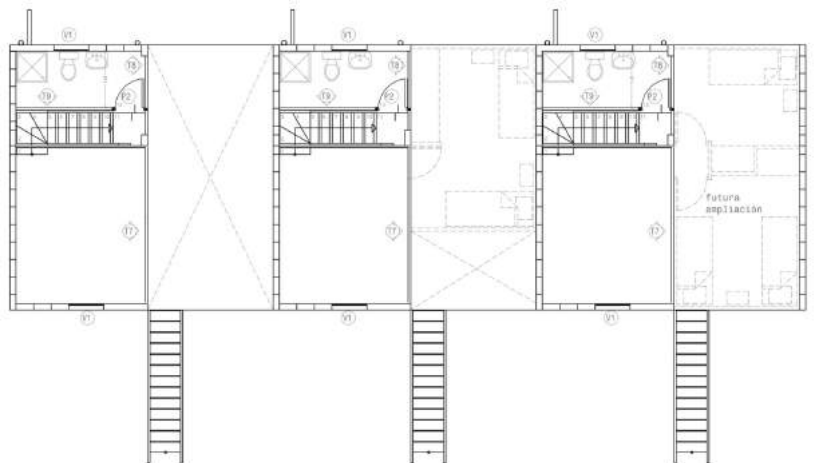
Aravena, Alejandro, ELEMENTAL, Quinta Monroy, Grundriss dritte Ebene, 2003.
